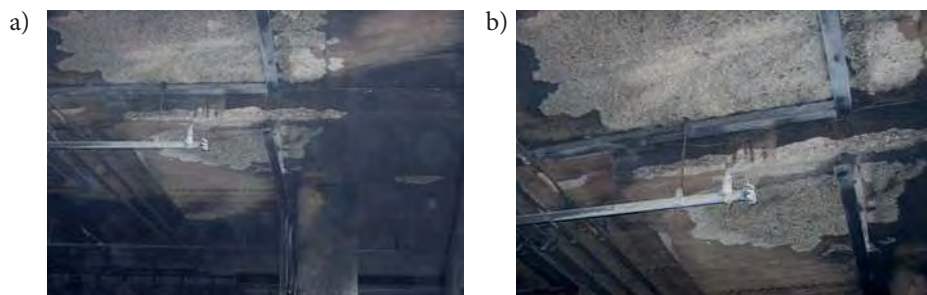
Odpryskiwanie betonu płyty stropowej: a) wygląd ogólny; b) zbliżenie [fot. autora]
